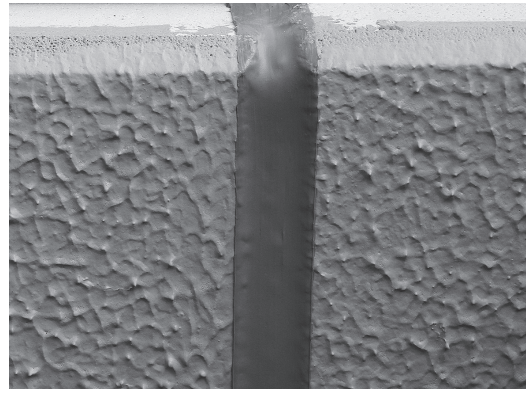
セメダイン EXCEL II の施工状況 (アップ)
